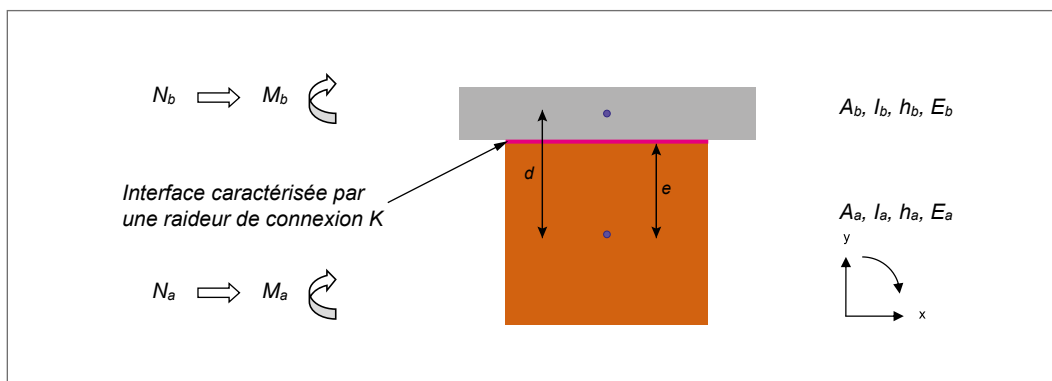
Paramètres d'étude de la section mixte en flexion simple
